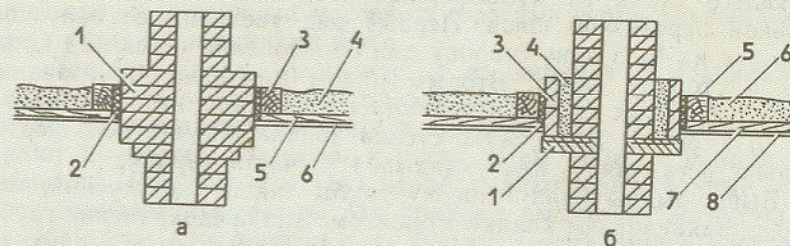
Устройство горизонтальной противопожарной разделки у дымовой трубы в уровне чердачного или междуэтажного перекрытия:
